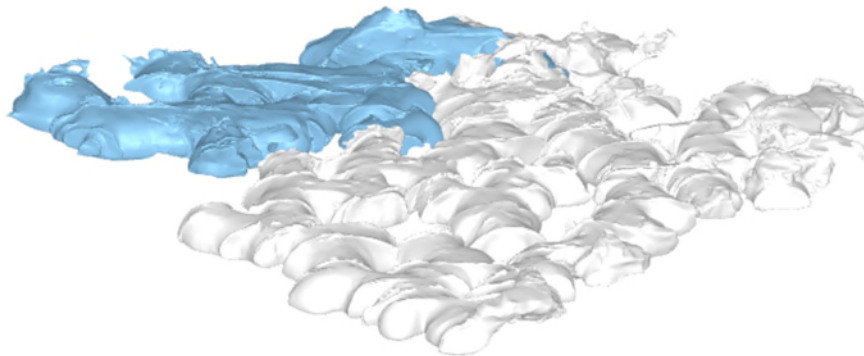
Vermessung der Hohlräume des Stufensandabbaus in Jena Dornheim (Länge Hauptgewölbetonnen= 90 m, Oberfläche 2300 m²)
